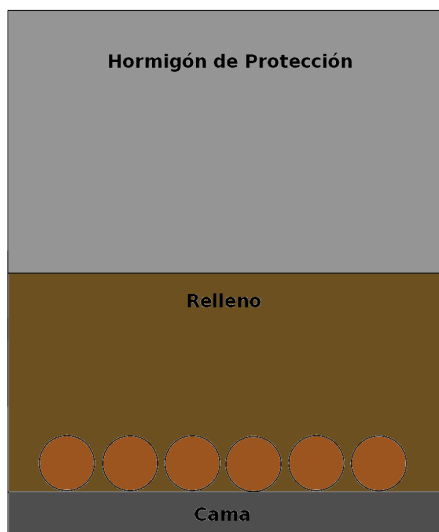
Sección transversal de la zanja para los tubos de transporte del agua de riego.
